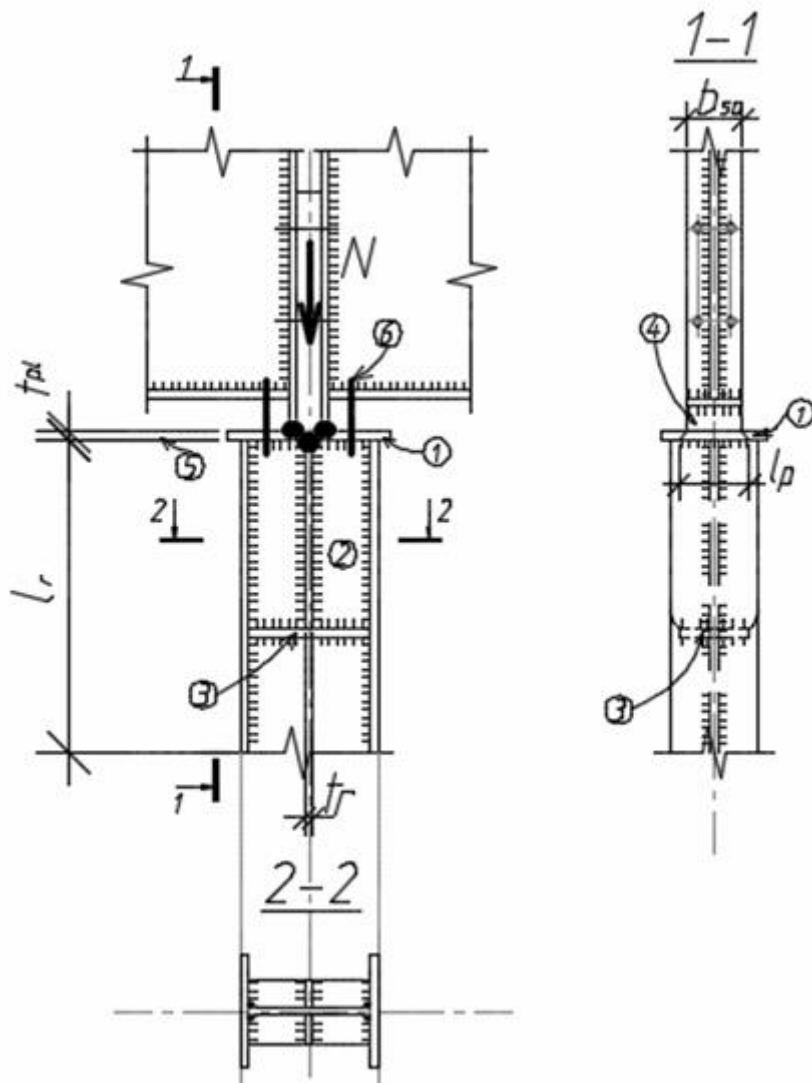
Конструкція оголовка із спиранням балок зверху (рис. 2.10, д)
